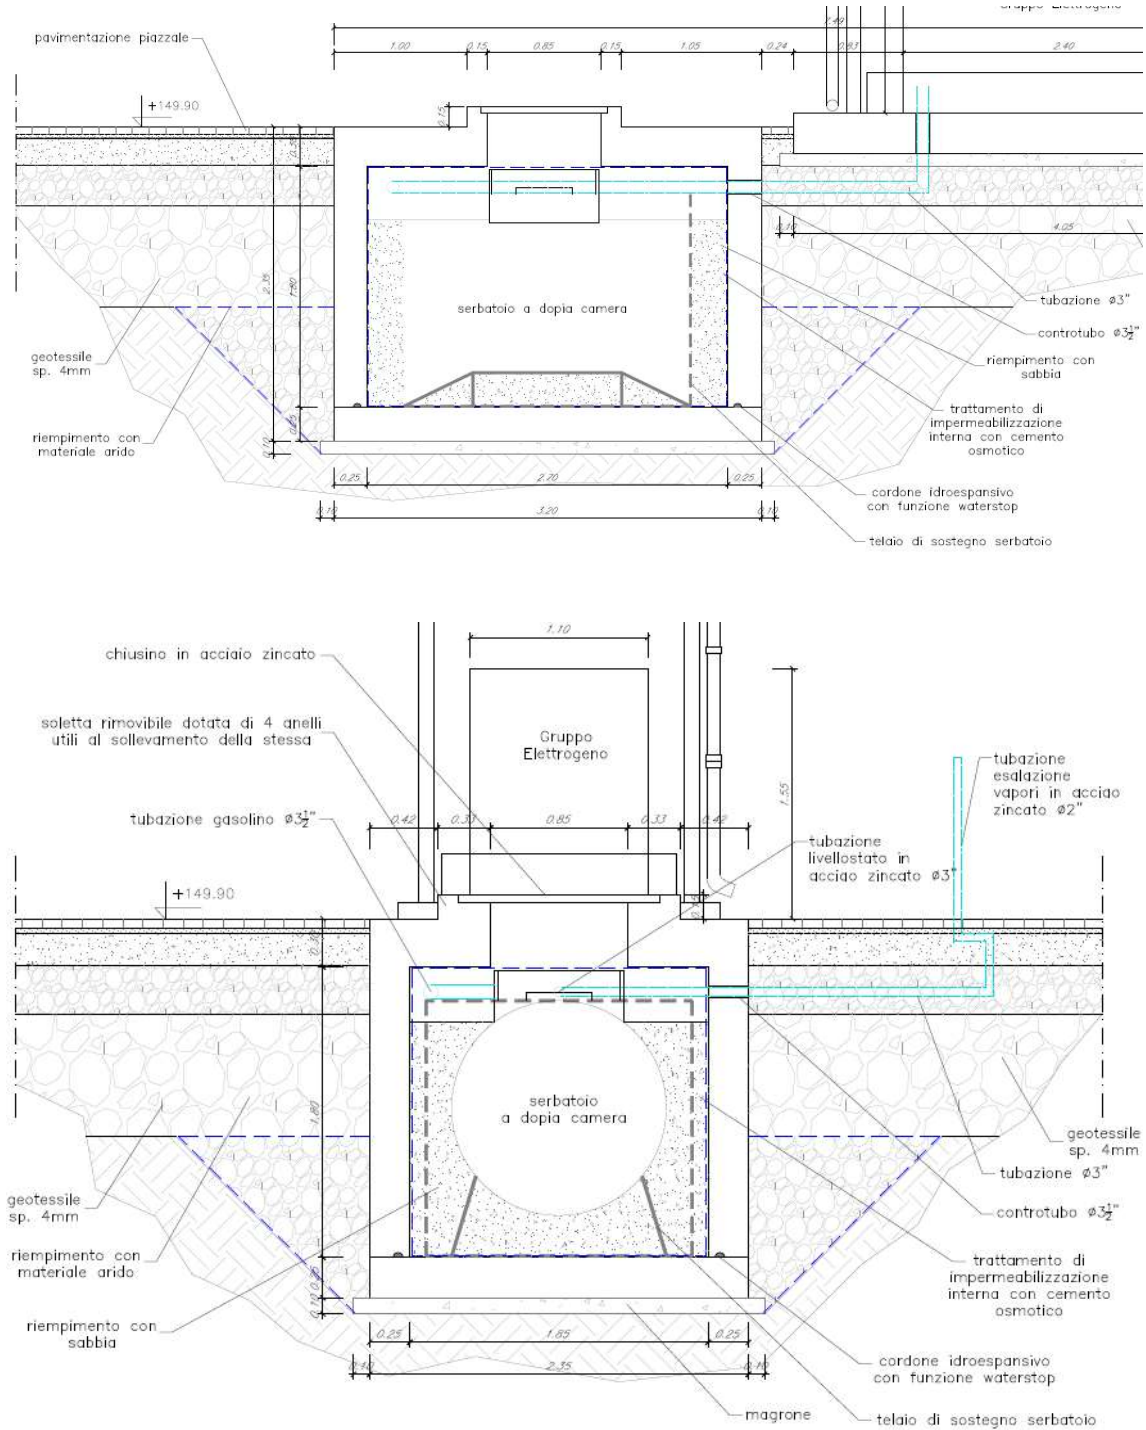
Vasca di serbatoio di GA1 PP/ACC Boschetto - Sezione longitudinale e trasversale
